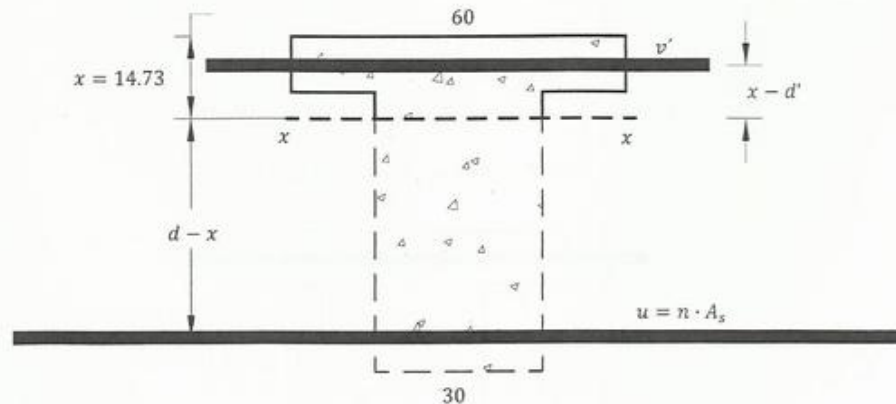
Viga del ejemplo 4.1 Sección T de concreto armado agrietada (con acero)
